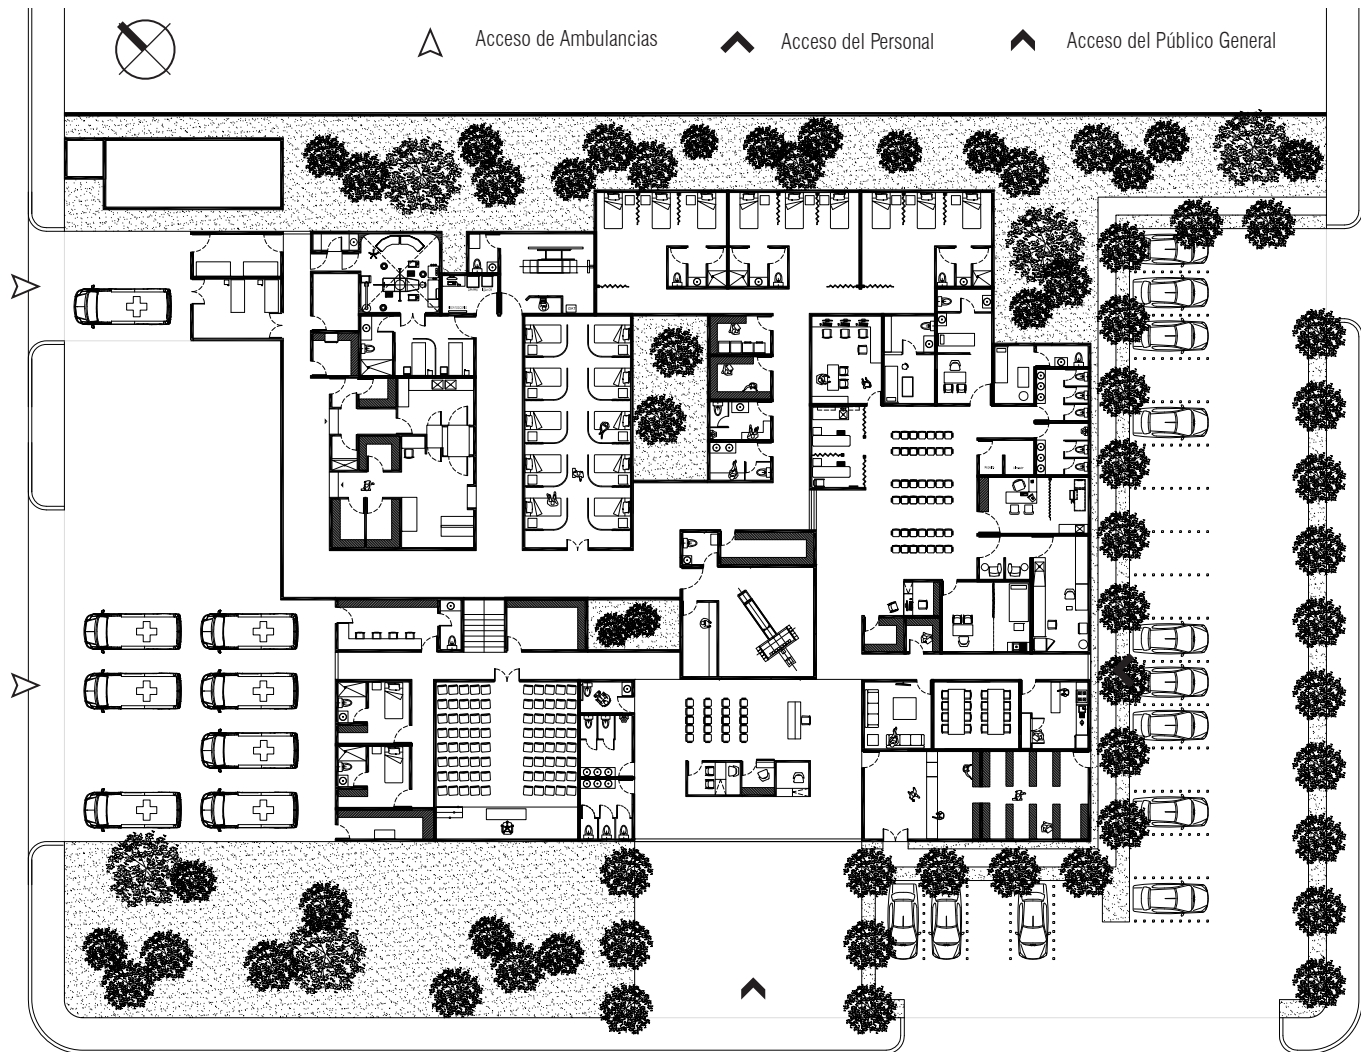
| Prototipo Delegación Completa para el grupo climático tres | Planta Baja
